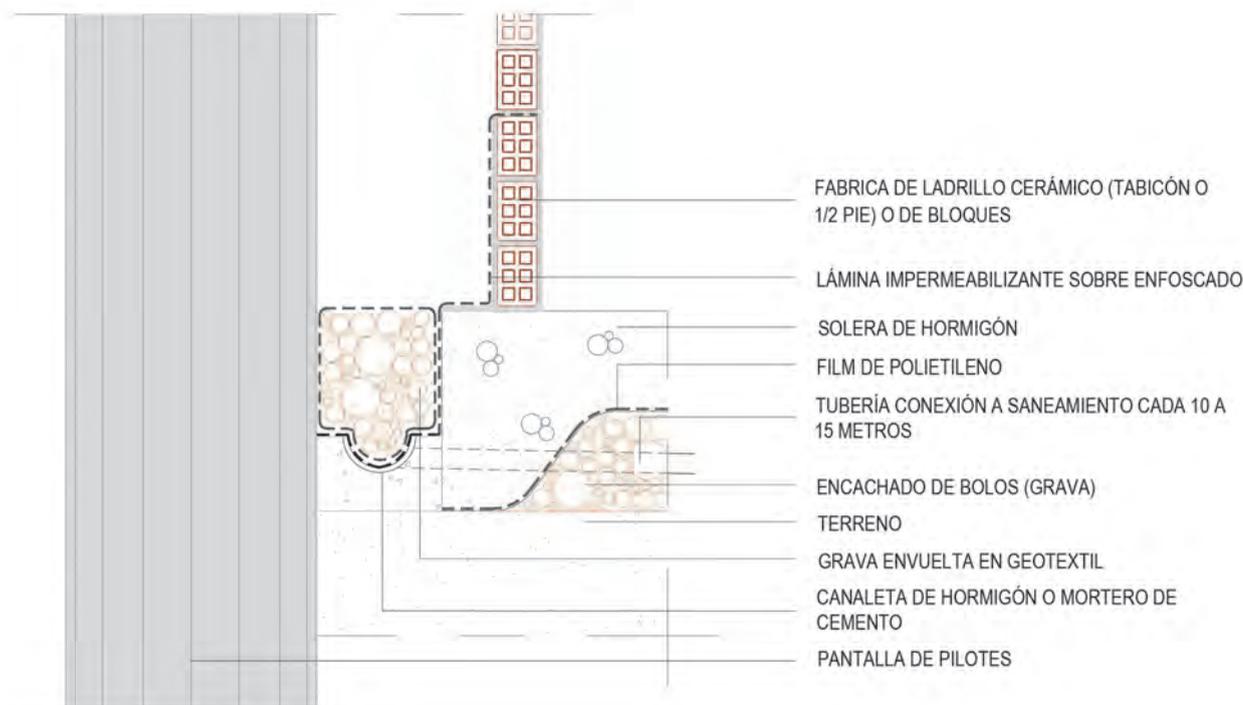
drenaje de pantalla de pilotes con cámara bufa.
